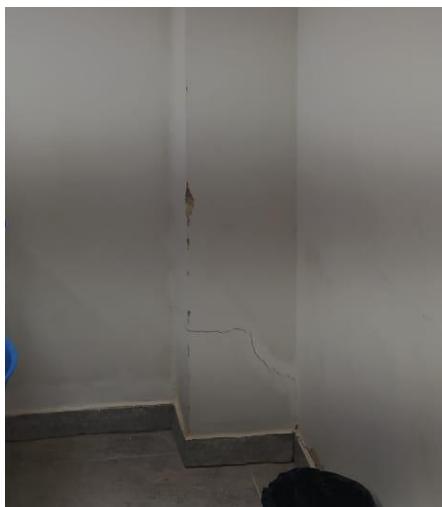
Fissura vertical em pilar interno no Hall de Entrada
